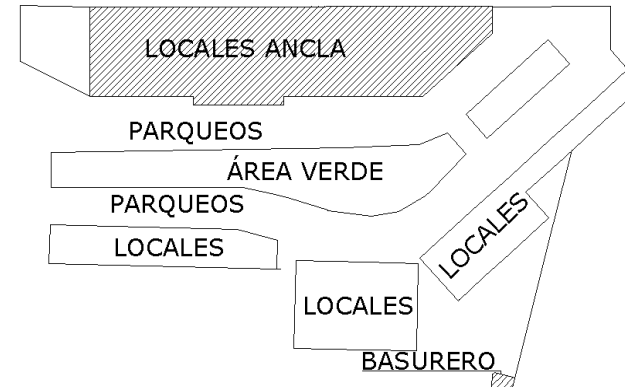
Esquema de distribución. Centro Comercial "Galerías del Sur". Fuente: Elaboración propia.
